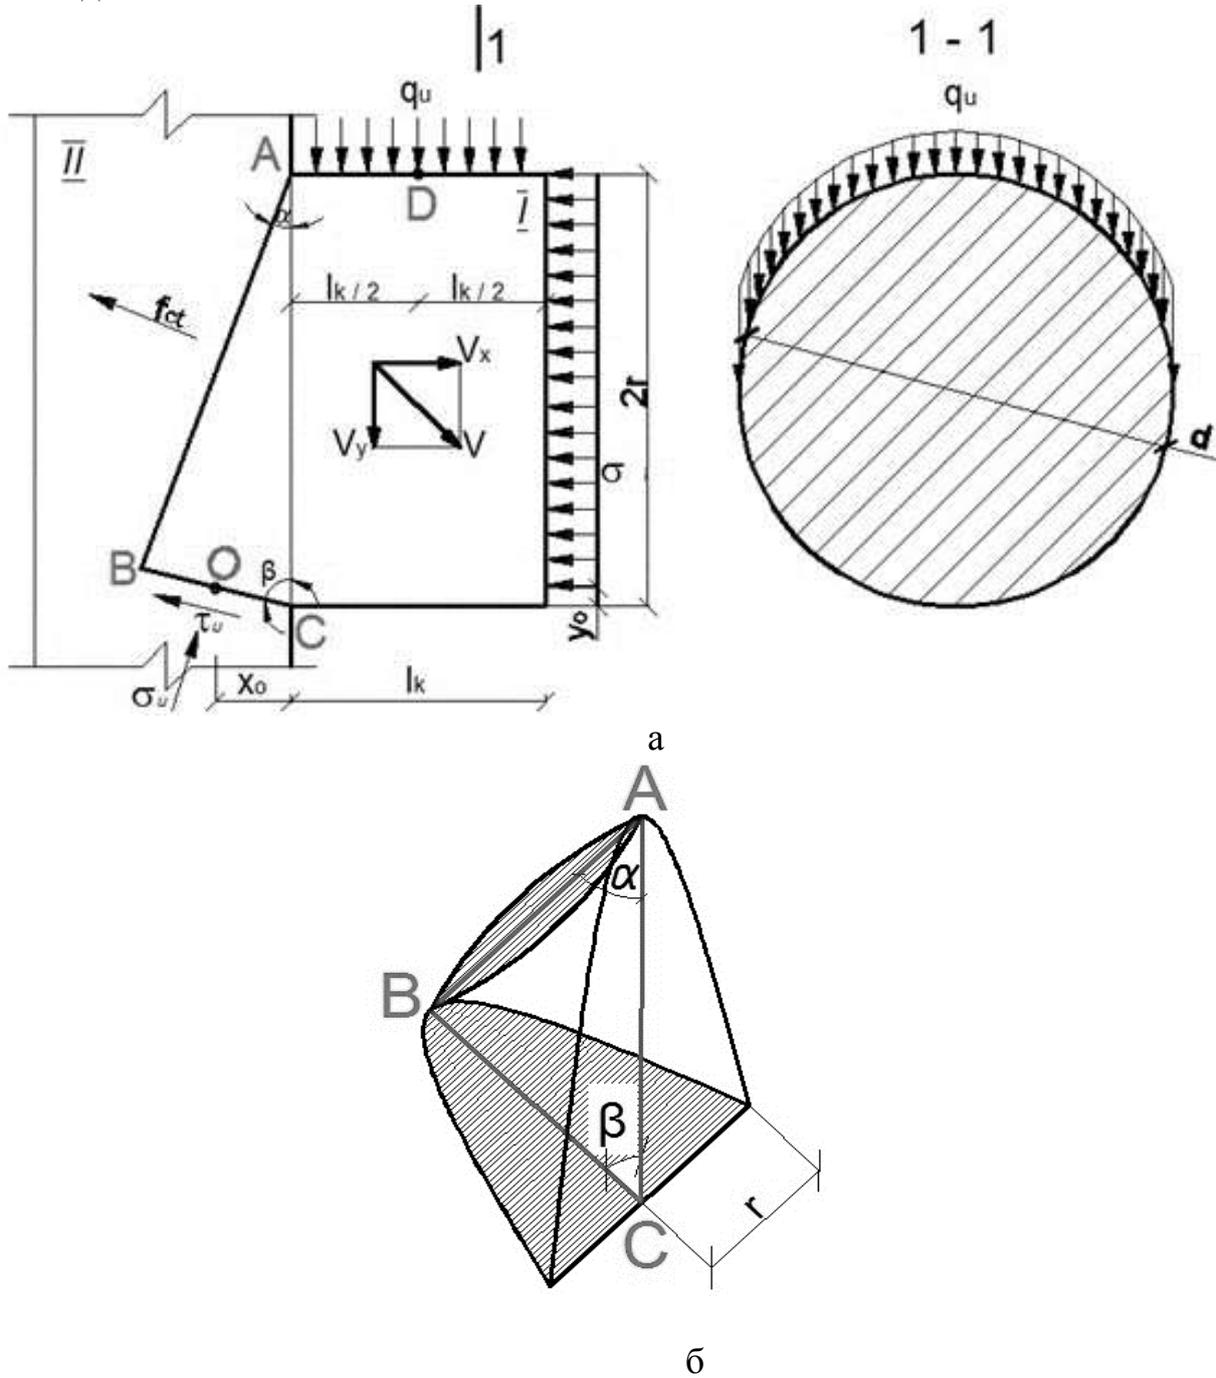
Кінематично можлива схема руйнування круглих обтиснутих бетонних шпонок при зрізі (а) і ділянки поверхні руйнування у формі параболи (б)
